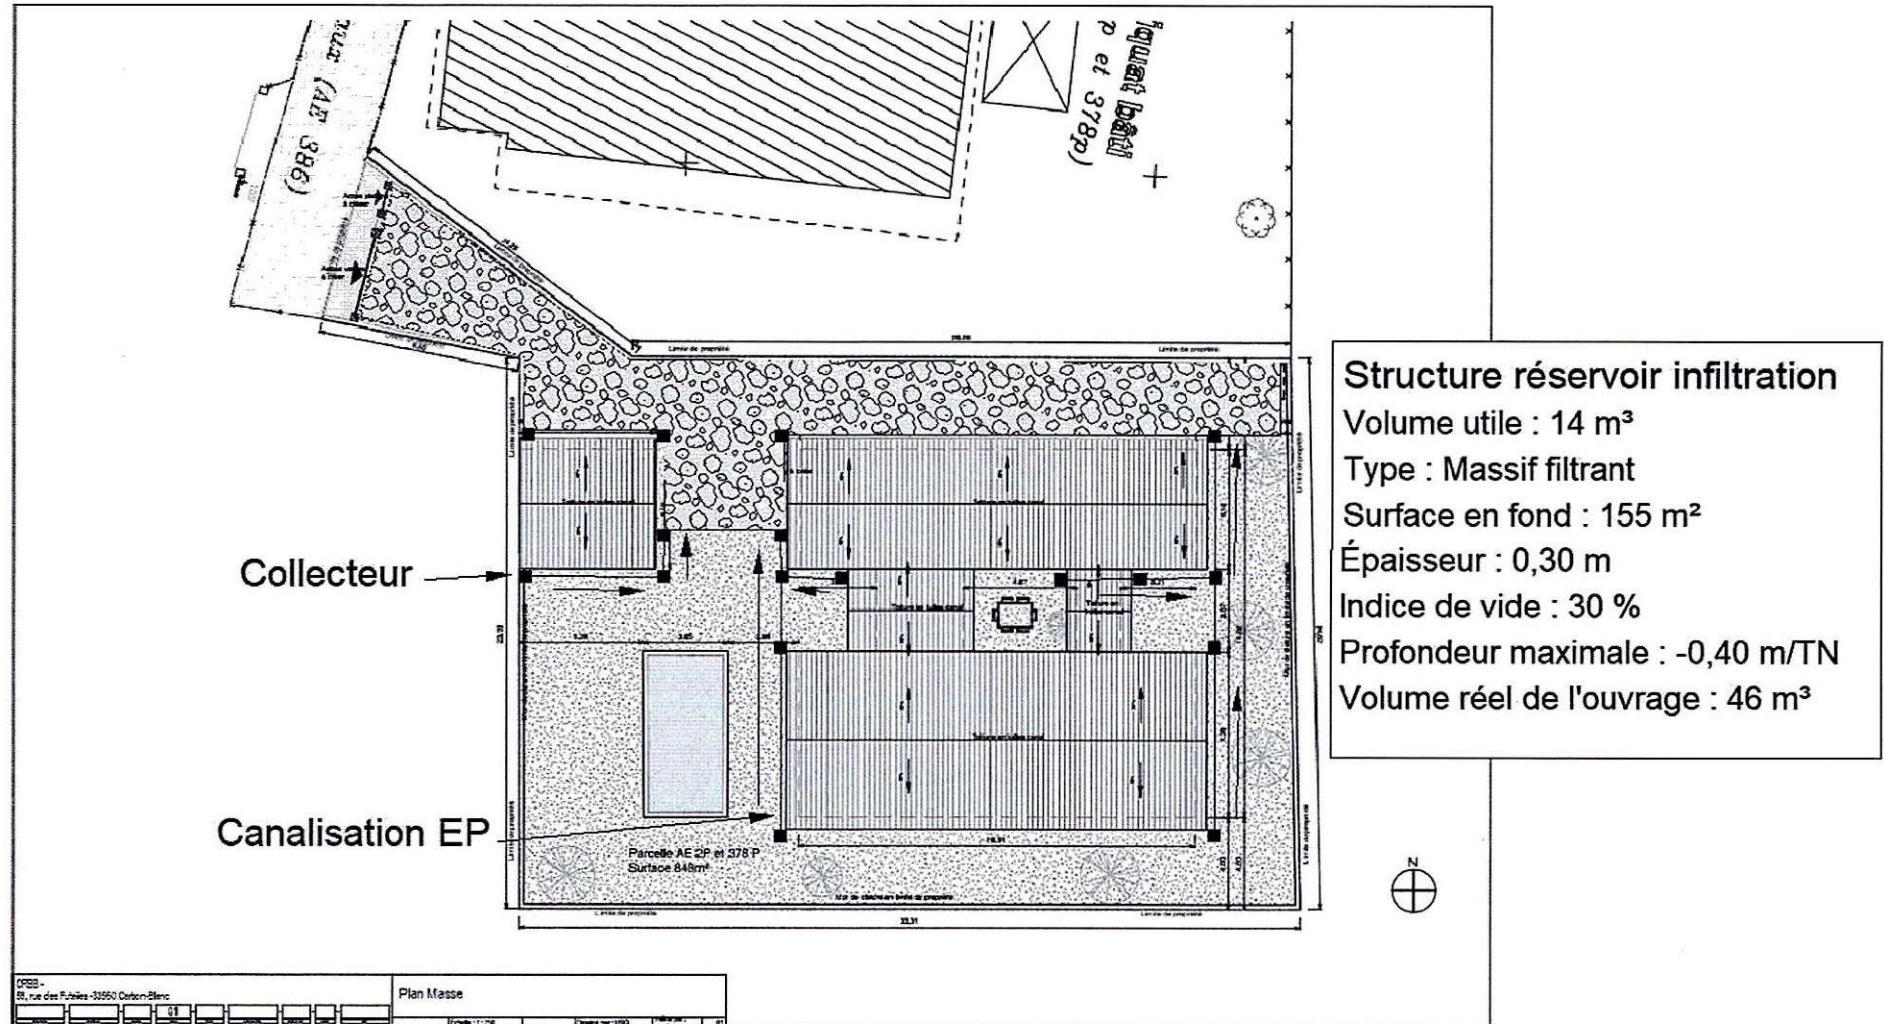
Plan de principe d'implantation de la filière de gestion des eaux pluviales (ENDEO Environnement)
